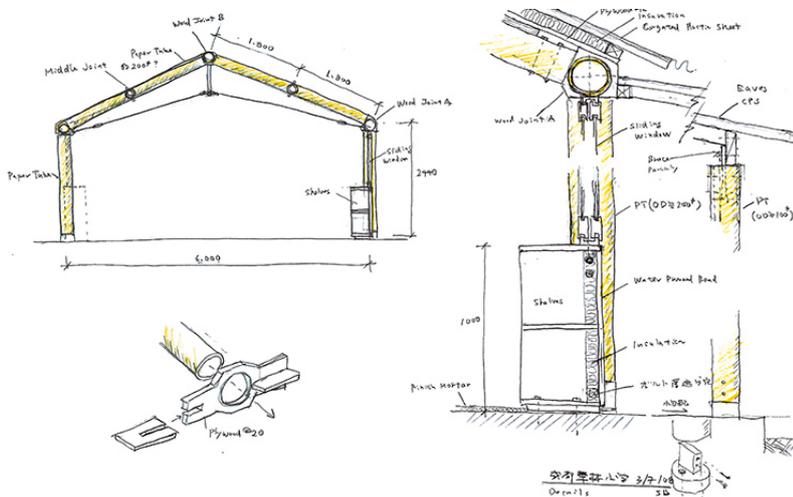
Secciones constructivas con medidas y detalles para su construcción.
